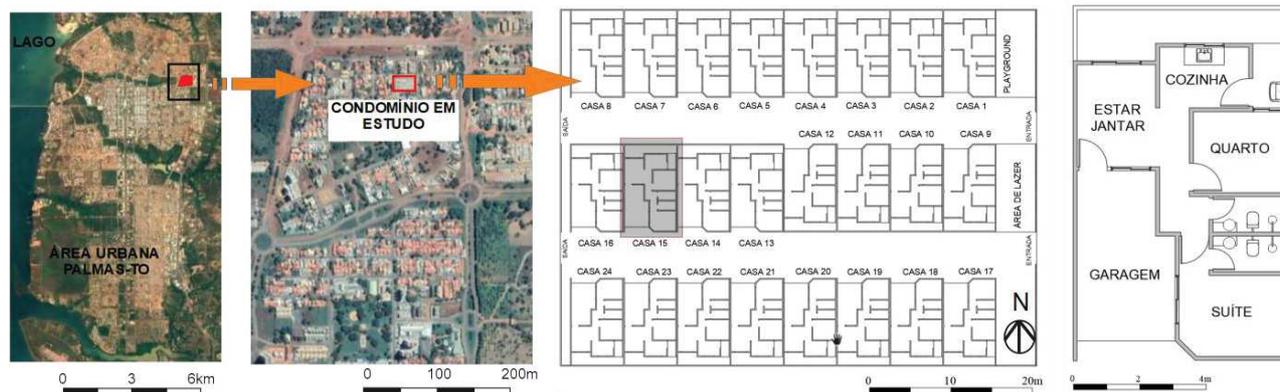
Localização do condomínio e planta baixa da edificação em estudo
